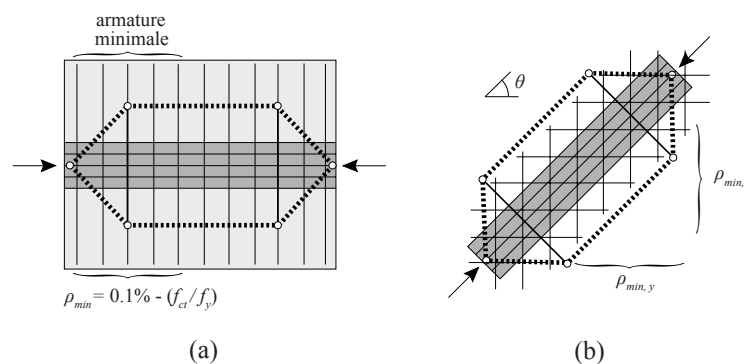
(a) Bielle de compression avec armature perpendiculaire à la direction de la fissuration; (b) bielle de compression avec armature inclinée par rapport à la direction de la fissuration.
